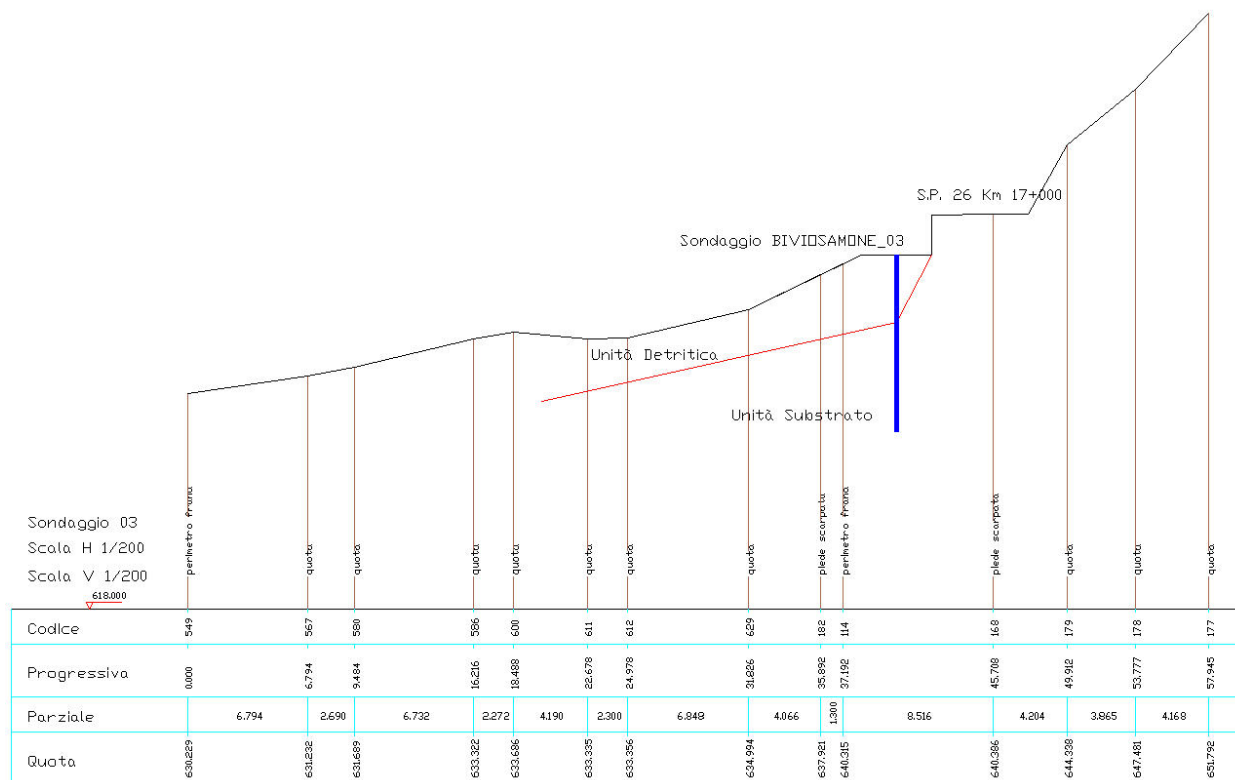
Sezione litotecnica coincidente con la sezione topografica n. 3 (precedente alla realizzazione dei drenaggi)
